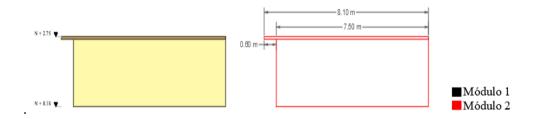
Vista y dimensionamiento de fachada lateral derecha de la vivienda mínima modular.
